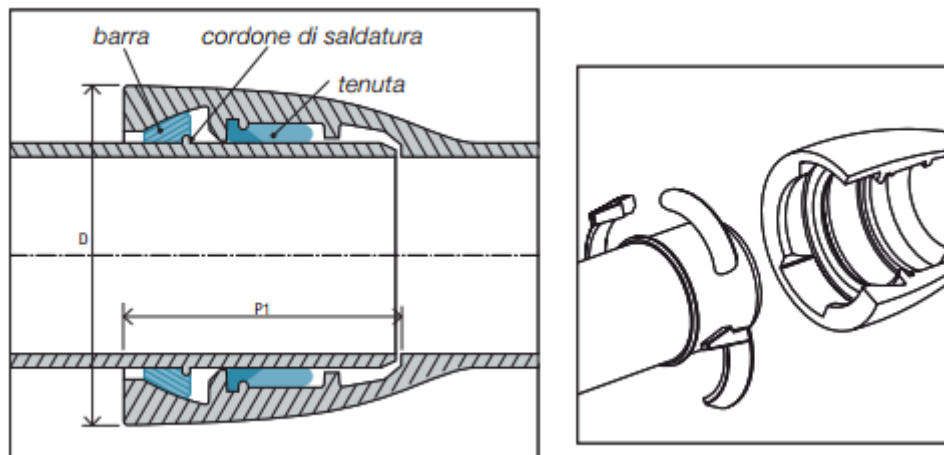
schema di un giunto a bicchiere con dettaglio delle estremità maschio e femmina. Fonte: www.strohr.at/it/
